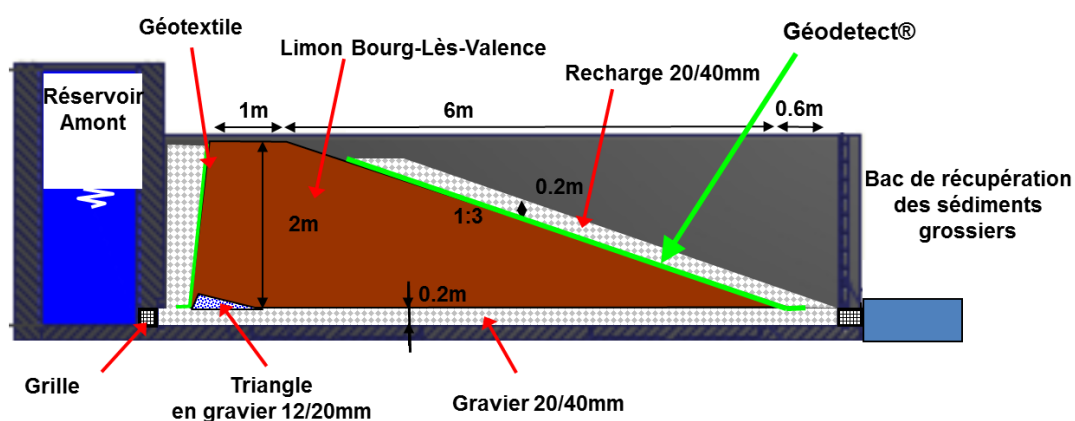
Schéma de l'ouvrage de l'essai 8.
